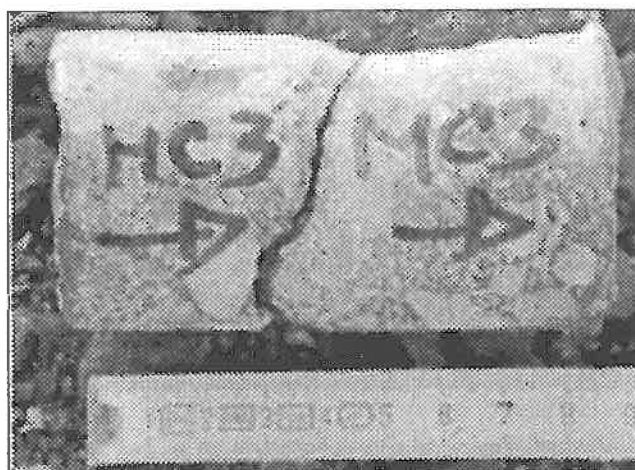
Carota prelevata da una trave esposta alla fiamma.
